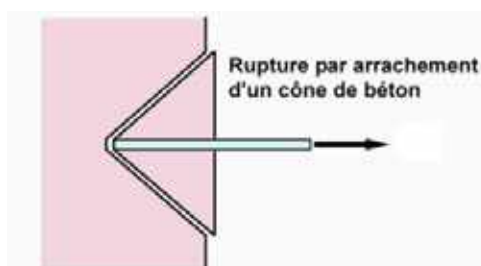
rupture par arrachement d'un cône de béton (essai non confiné)
